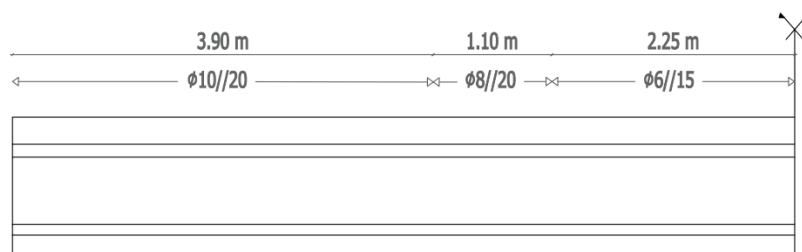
Armadura transversal da viga composta do vão extremo (secção longitudinal da viga).
